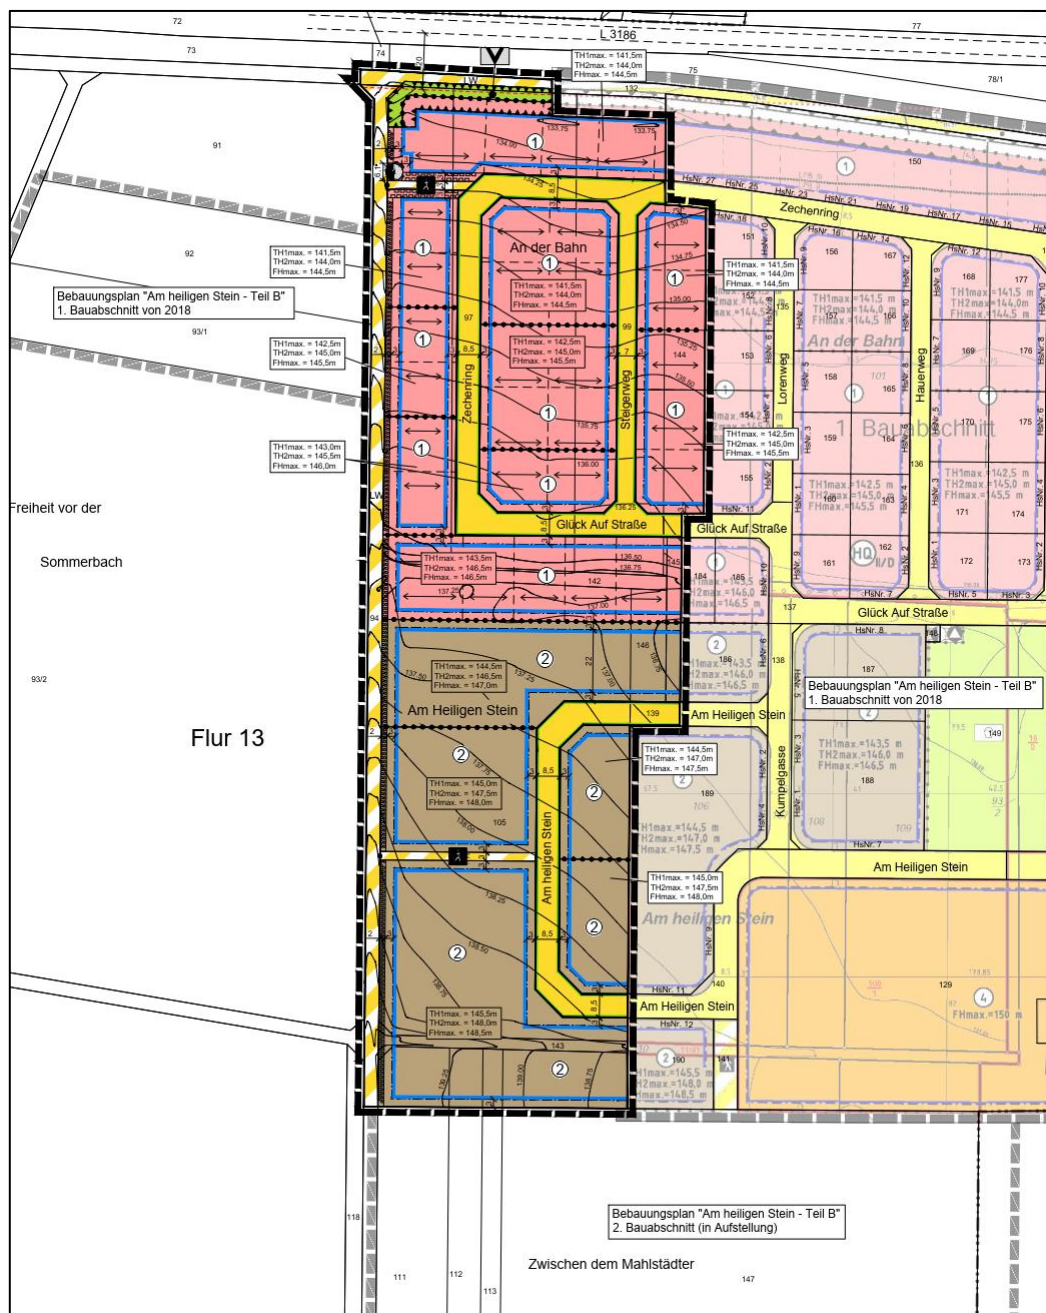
Ausschnitt Bebauungsplan Nr. 6.13 „Am heiligen Stein - Teil B“ 3. Bauabschnitt (Stand 10/2021)
